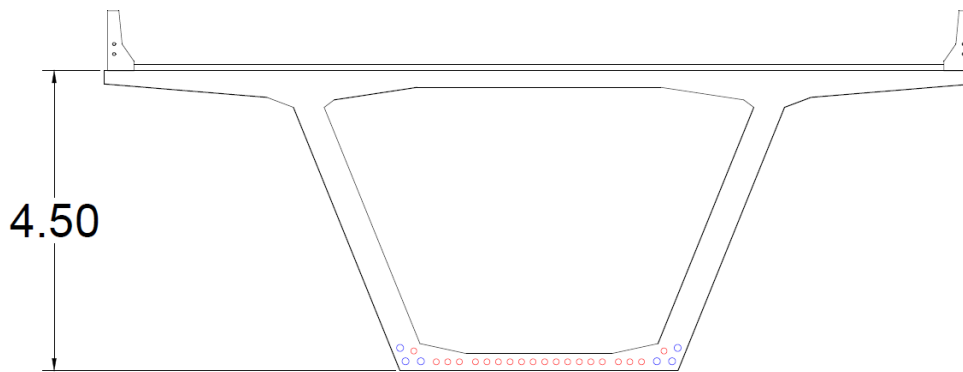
Distribuição da armadura de pré-esforço na secção 5 (junta) - dimensões em [m]
